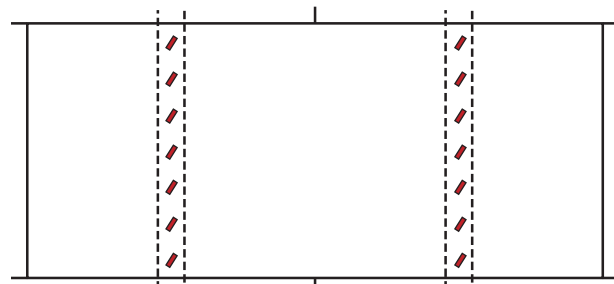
Mechanische Befestigung mittels Breitrückenklemmern
